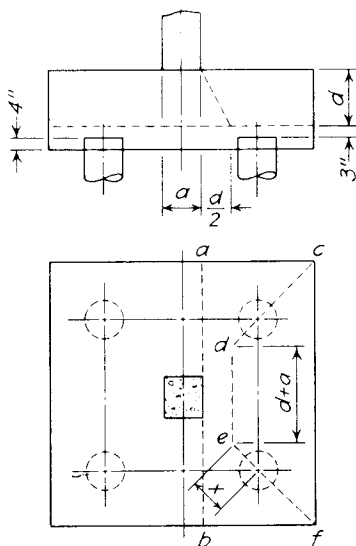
Zapata de concreto sobre pilotes, mostrando la sección crítica para proyecto.
